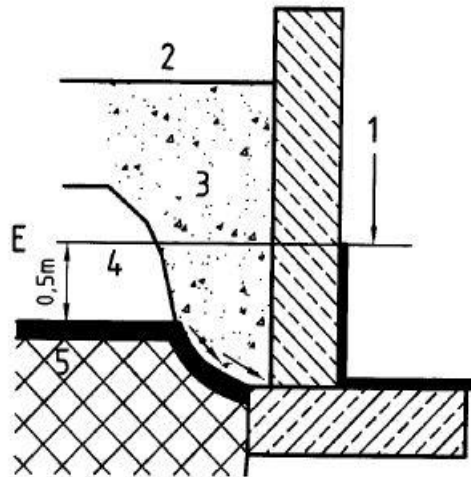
Exemple de cas d'eaux de ruissellement ou d'infiltration avec drainage avec revêtement.
